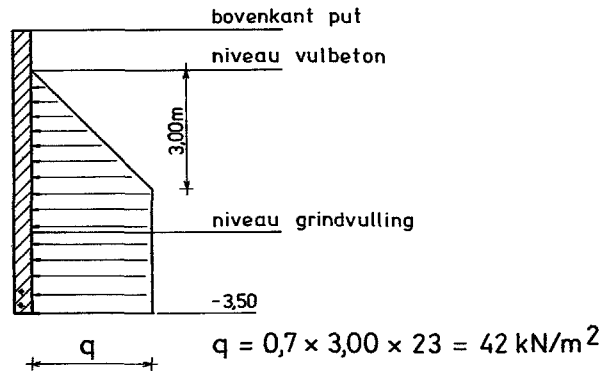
Draagende deel van de putrand, in de bouwfase, zonder betonvulling.
